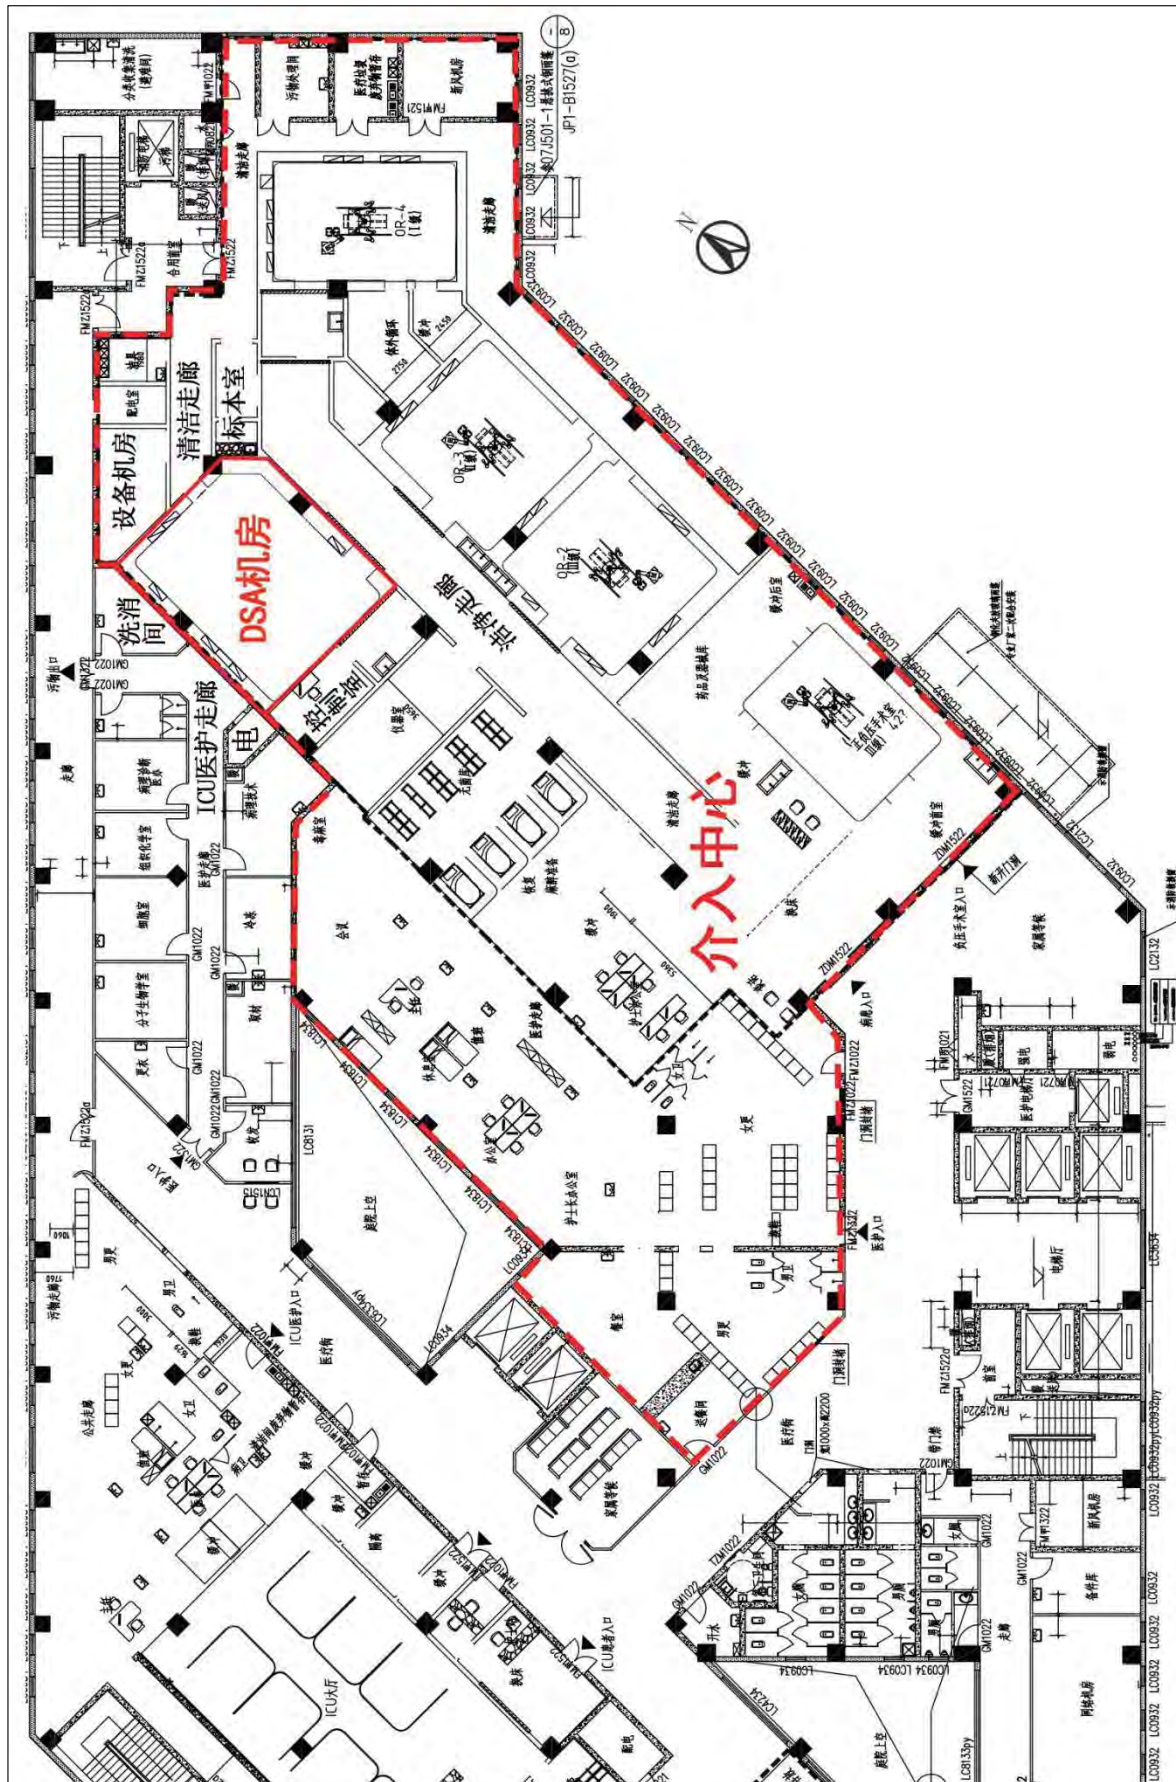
门诊住院综合楼三层总平面布置图 (局部)
